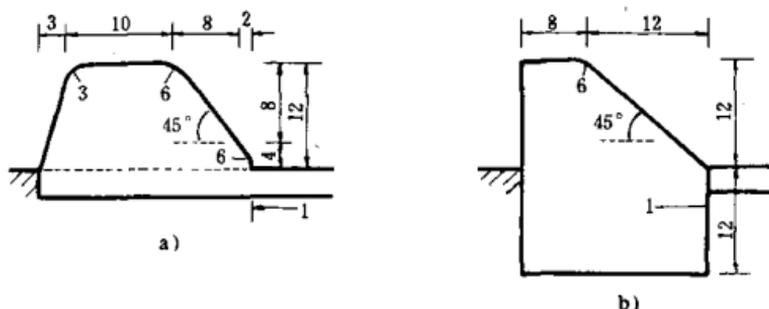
拦水带横断面参考尺寸(尺寸单位:cm)
